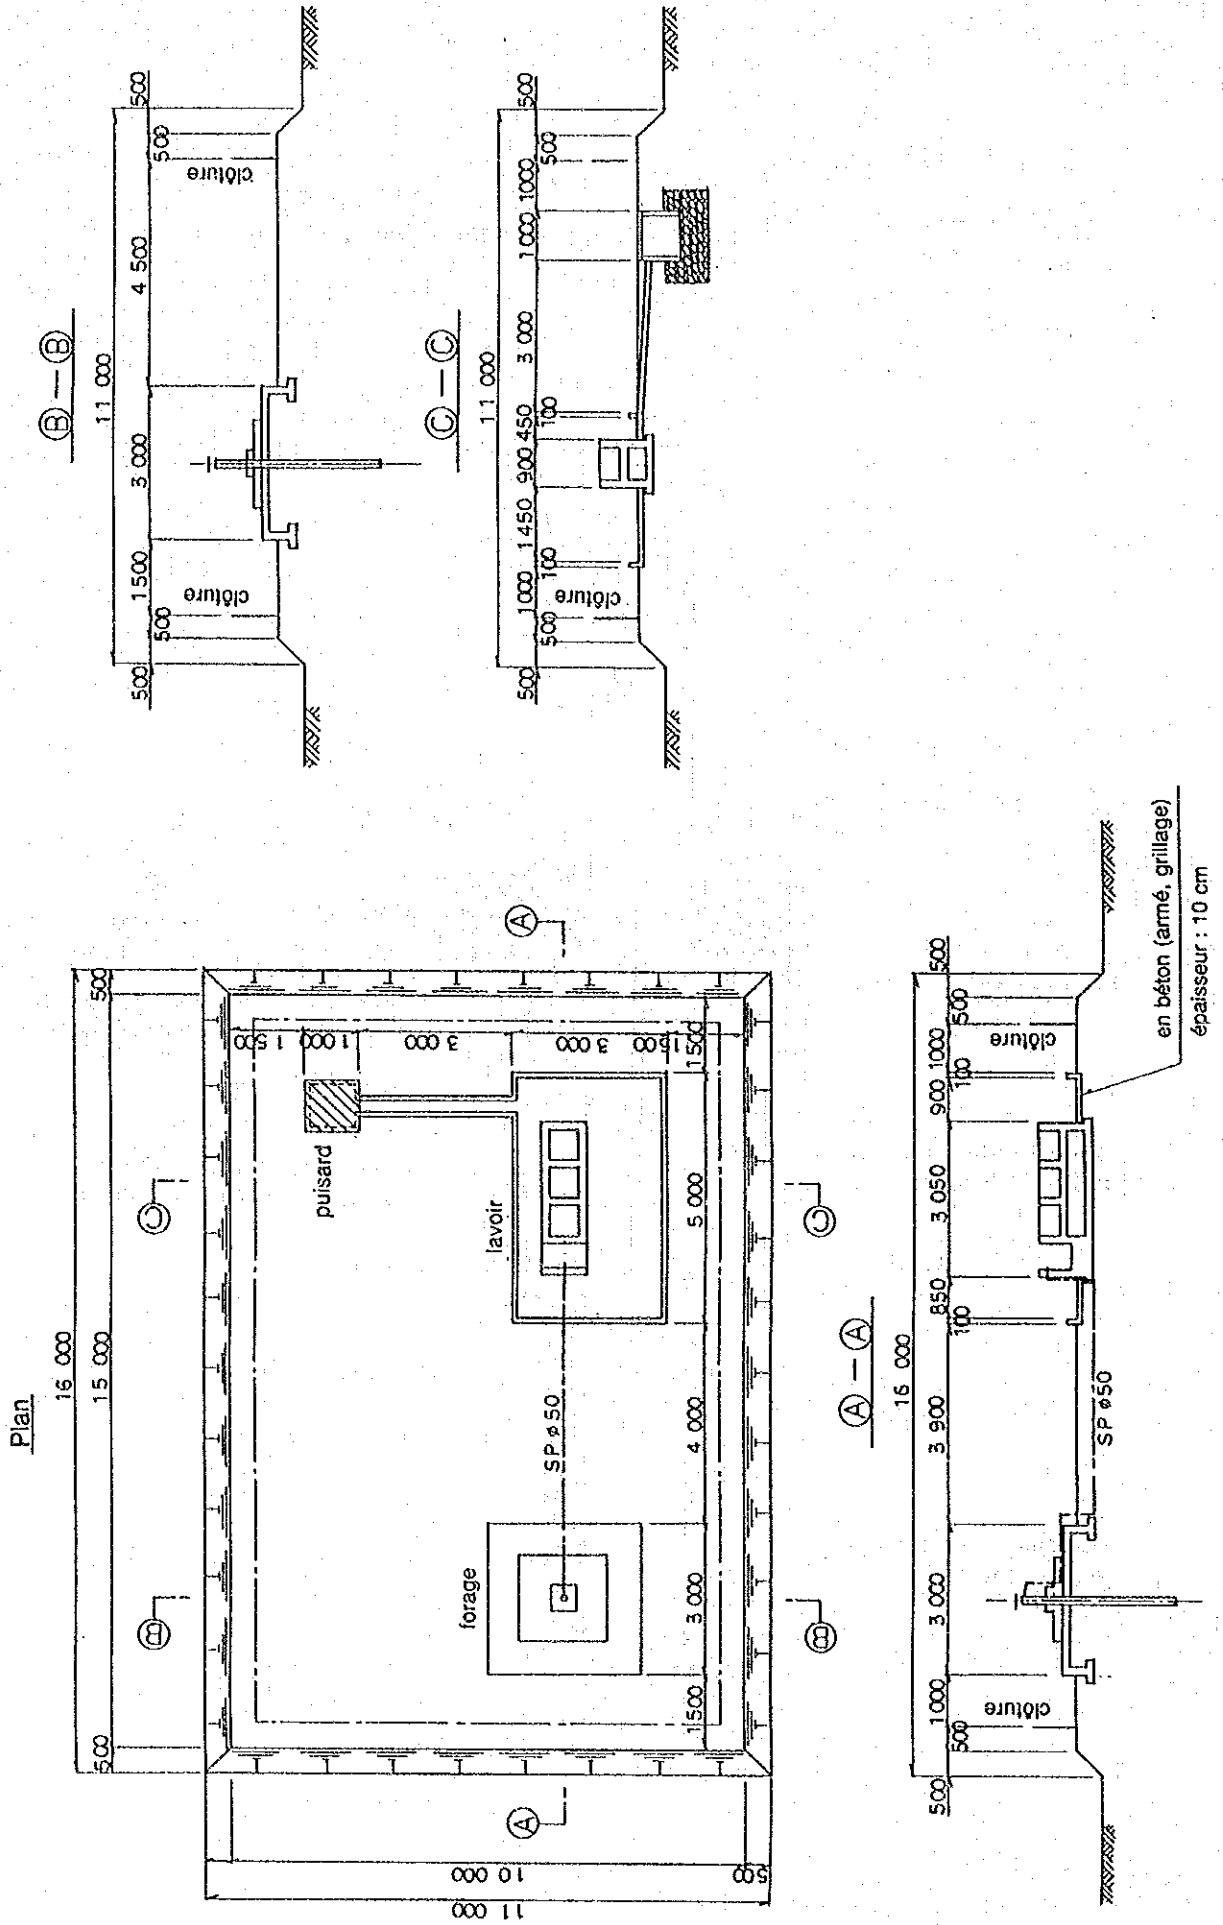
Plan détaillé de la pompe manuelle s = 1 : 30
